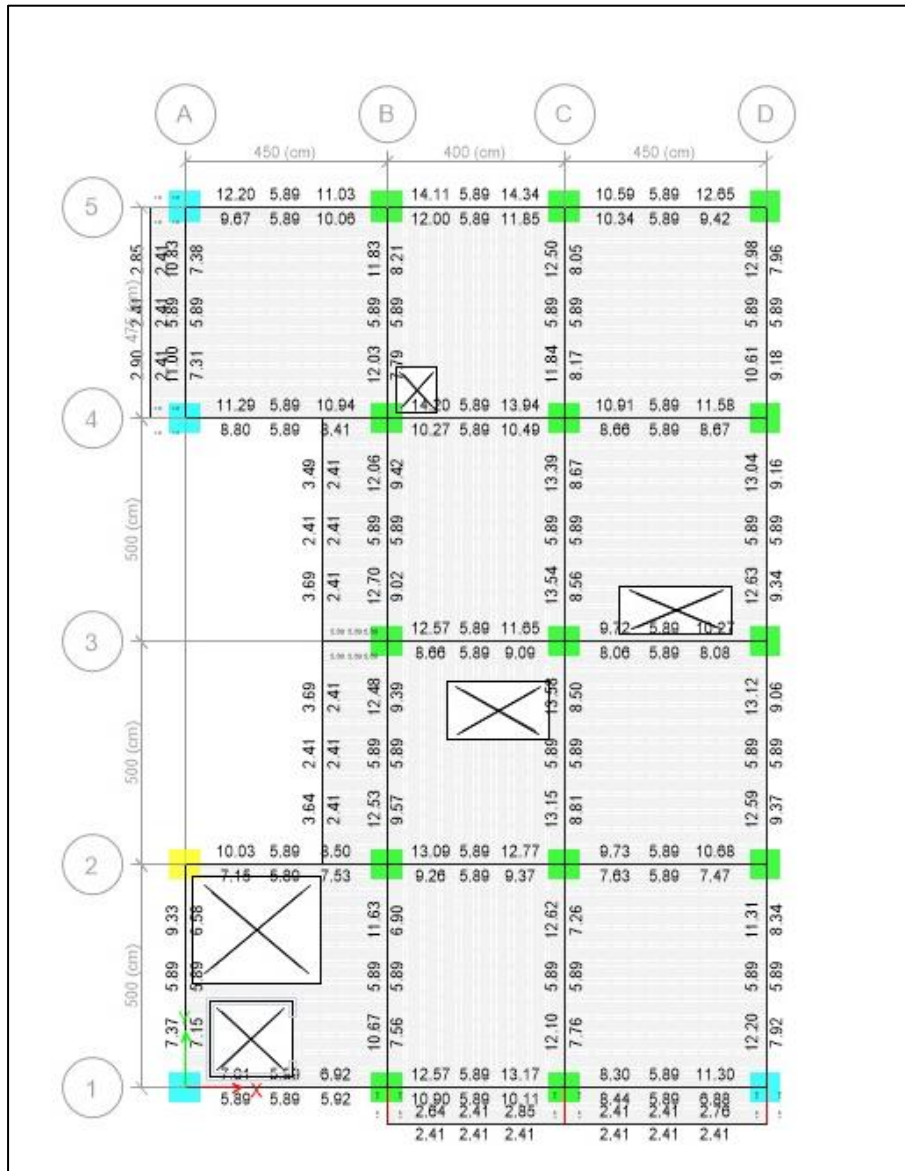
Cálculo de área de acero en vigas y columnas vista en planta
